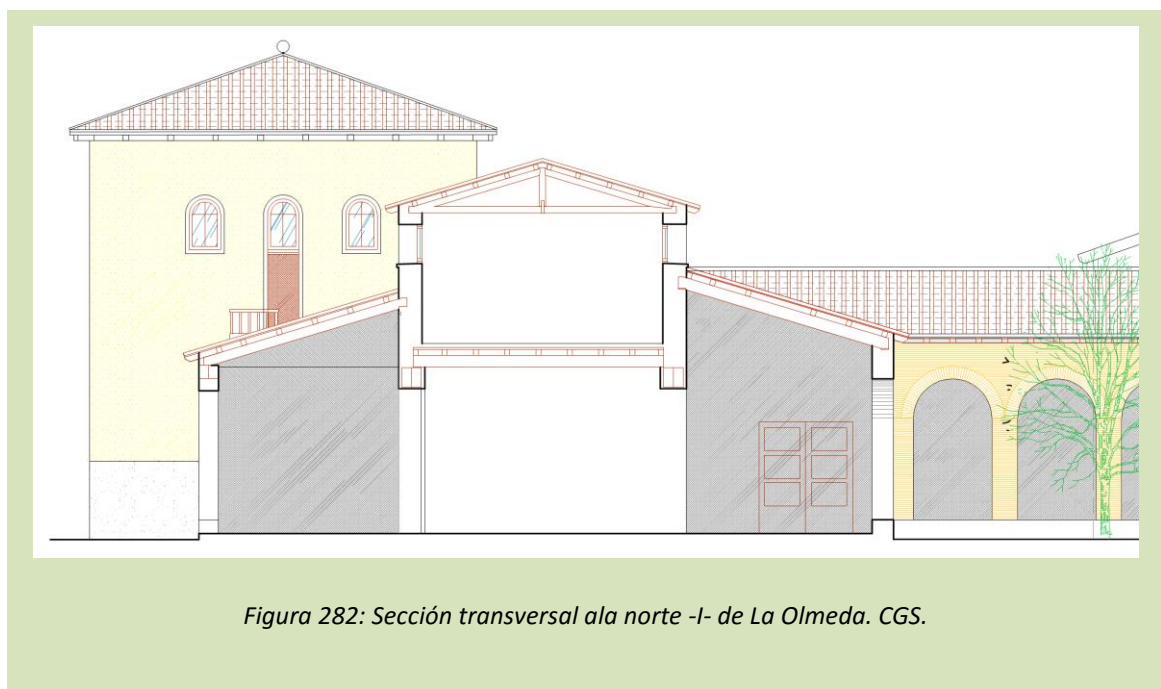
Sección transversal ala norte -I- de La Olmeda. CGS.
